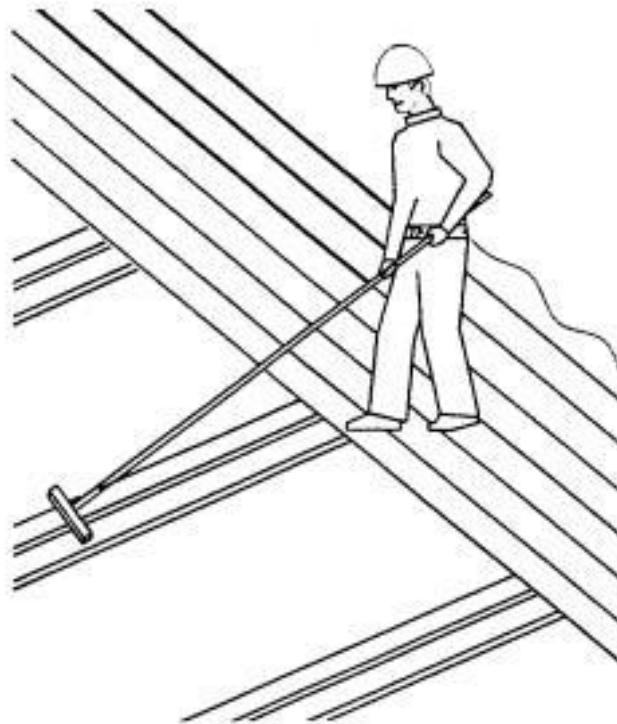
Очистка балок покрытия перед укладкой настила
